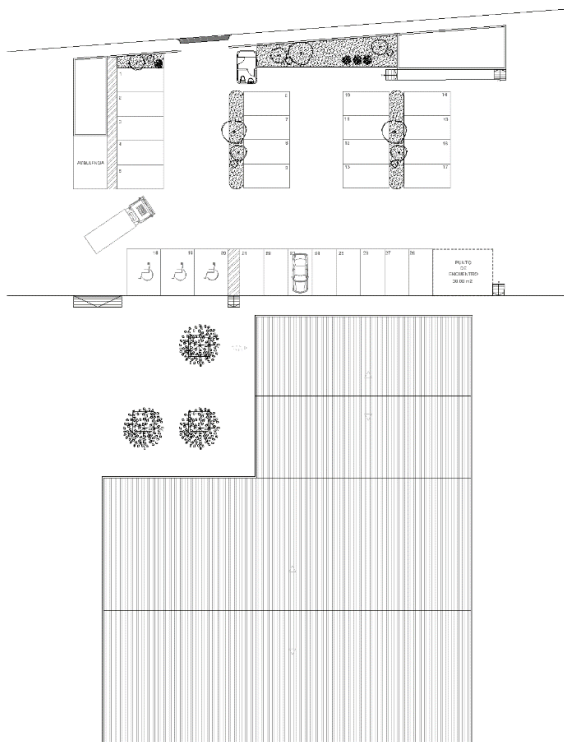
Planta de cubierta e imágenes del proyecto (Elaboración propia)
